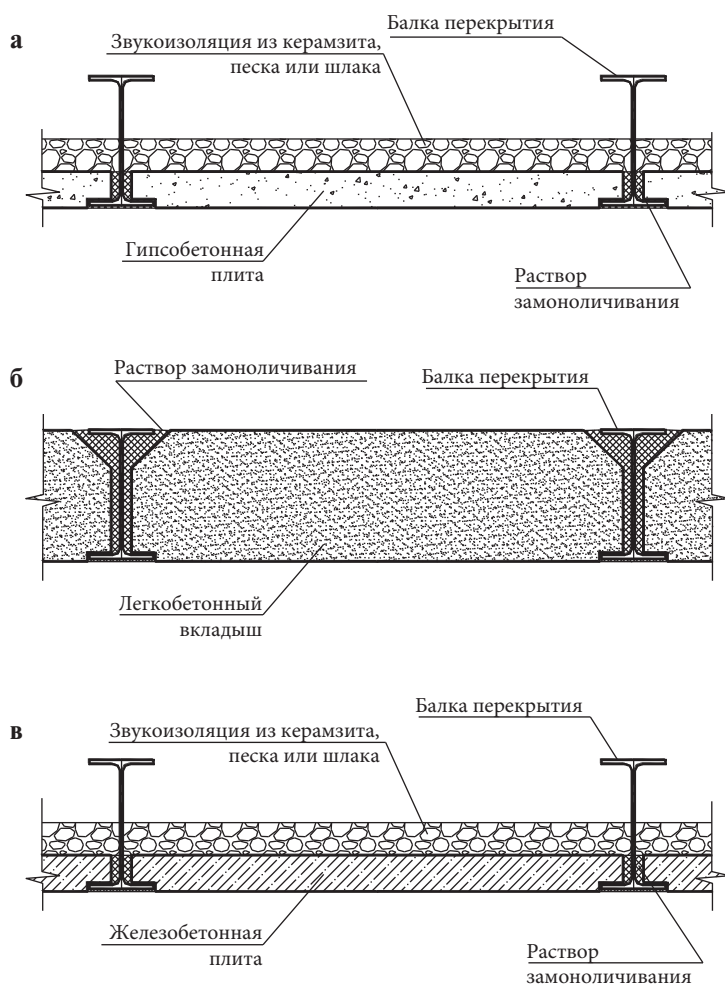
Перекрытия многоэтажных зданий со стальным каркасом с заполнением мелкокоразмерными элементами: а) гипсобетонными плитами; б) легкобетонными вкладышами; в) мелкокоразмерными железобетонными плитами
